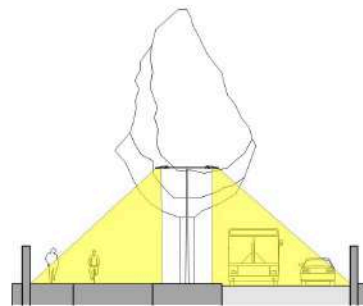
Schnitte B2 bis B5 der Planstraße A basierend auf dem städtebaulichen Entwurf
